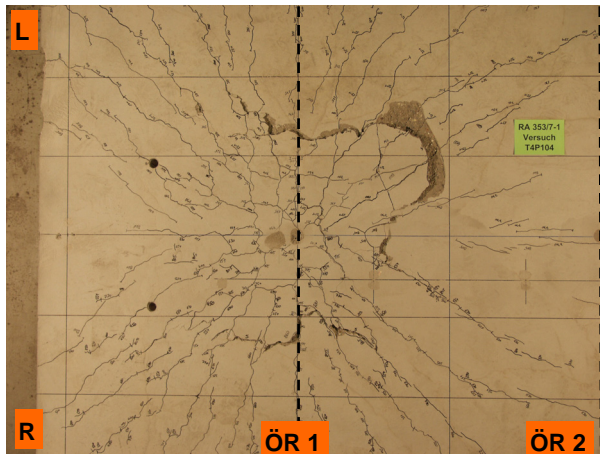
Rissbild auf der Betongurtoberseite, Detail am Öffnungsrand 1
